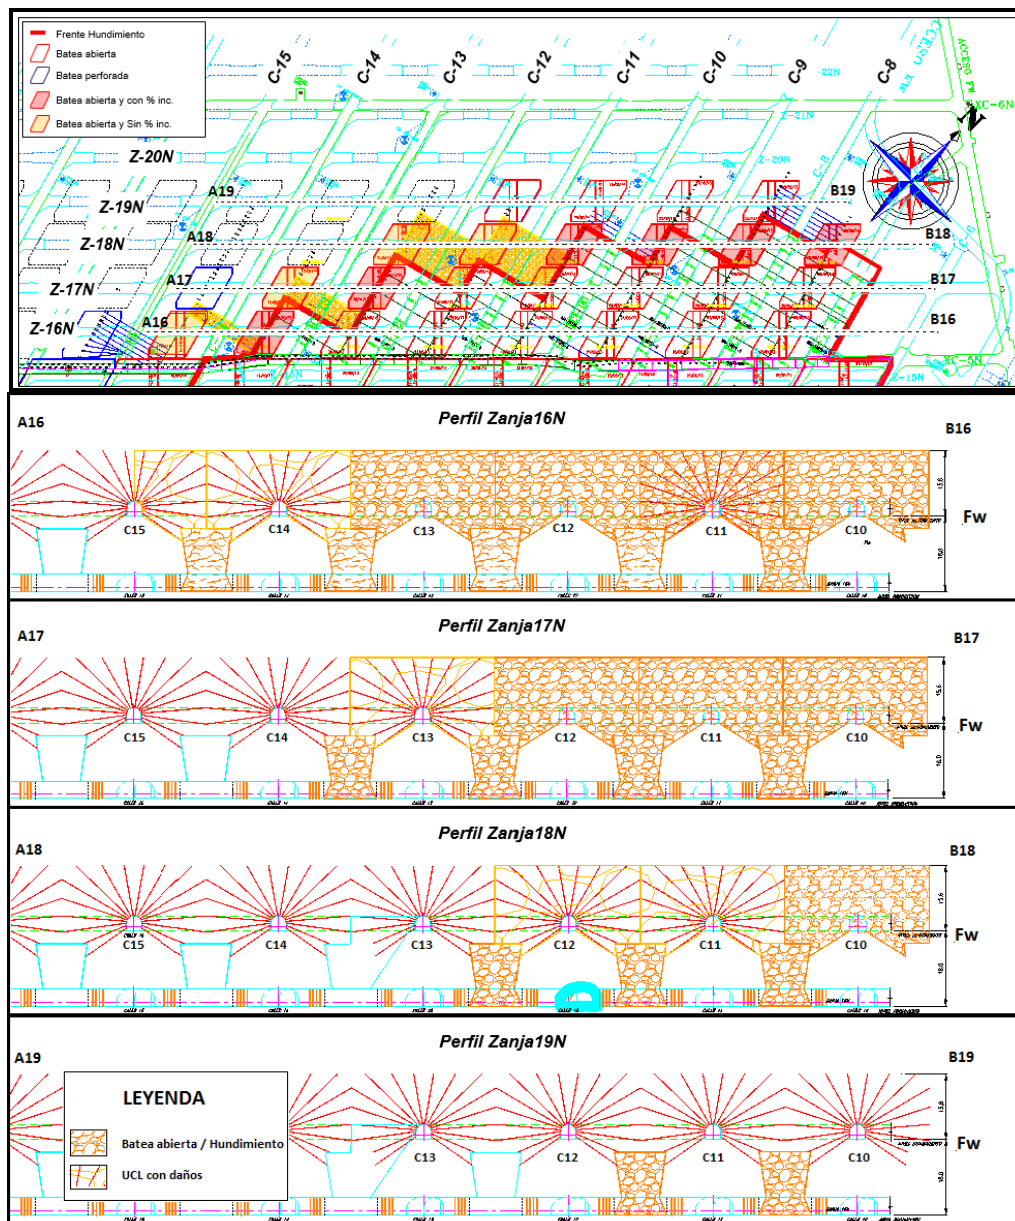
Vista en planta y perfil de zanja 16N a zanja 19N (Superintendencia Mina Norte (c) 2014).
